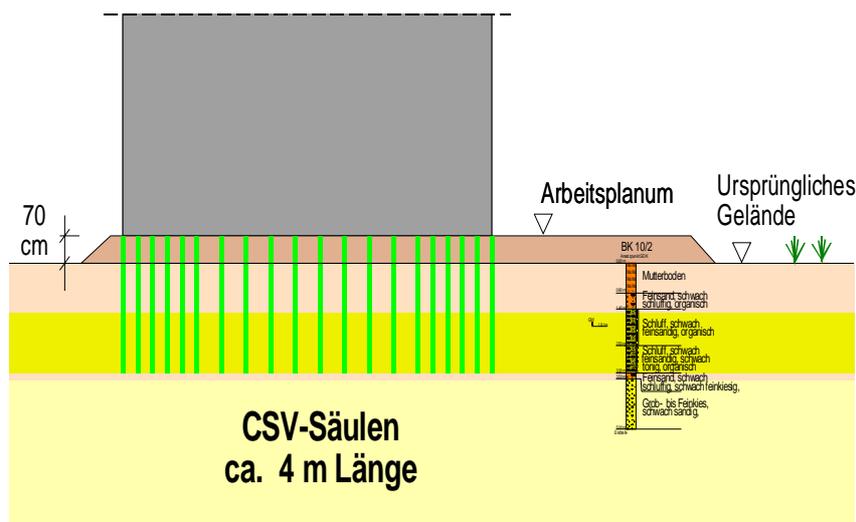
Stabilisierungssäulen als aufstehende Gründung
